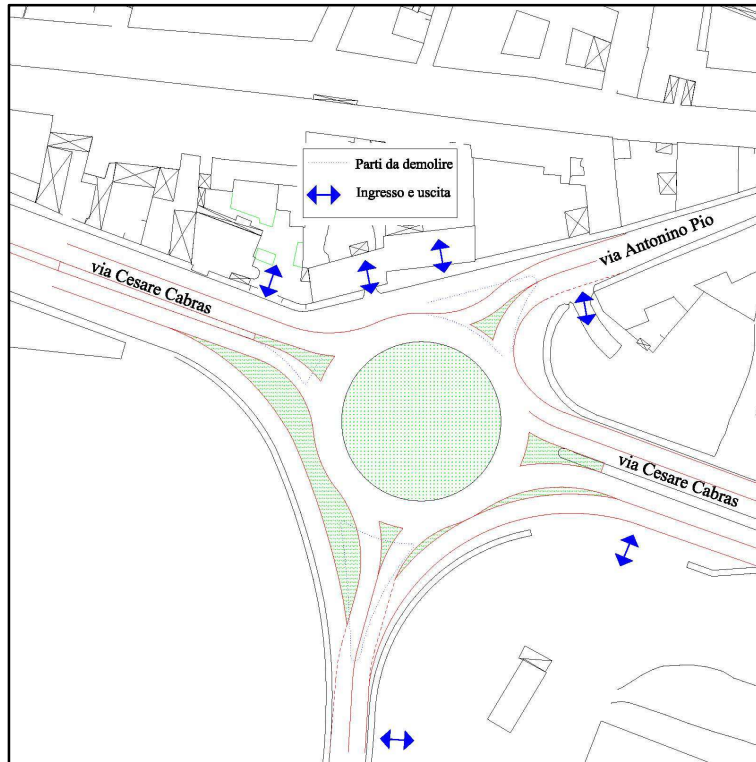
Sistemazione intersezione via Cesare Cabras - via Antonino Pio - Ponte Terramaini
